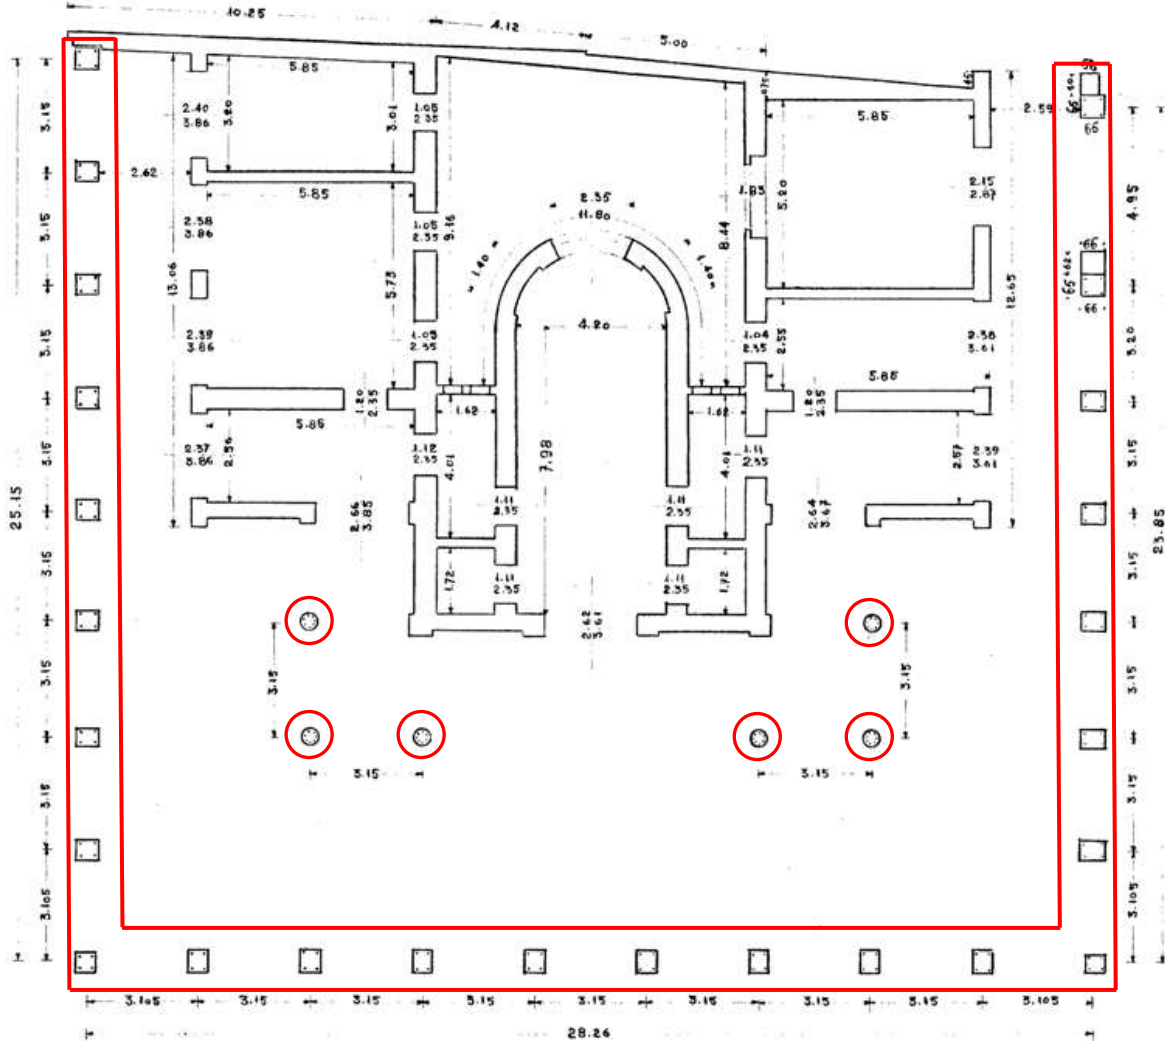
Pianta strutturale del piano terra risalente al 1937, con indicazione degli elementi in c.a.
